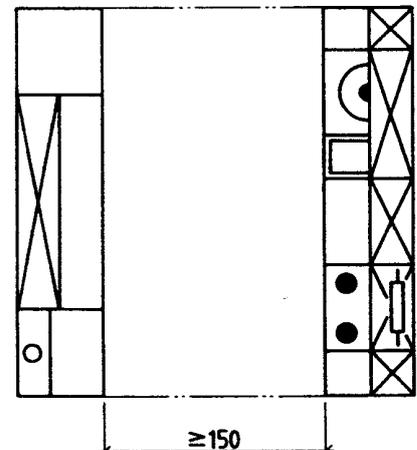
Bewegungsflächen in einer zweizeiligen Küche
